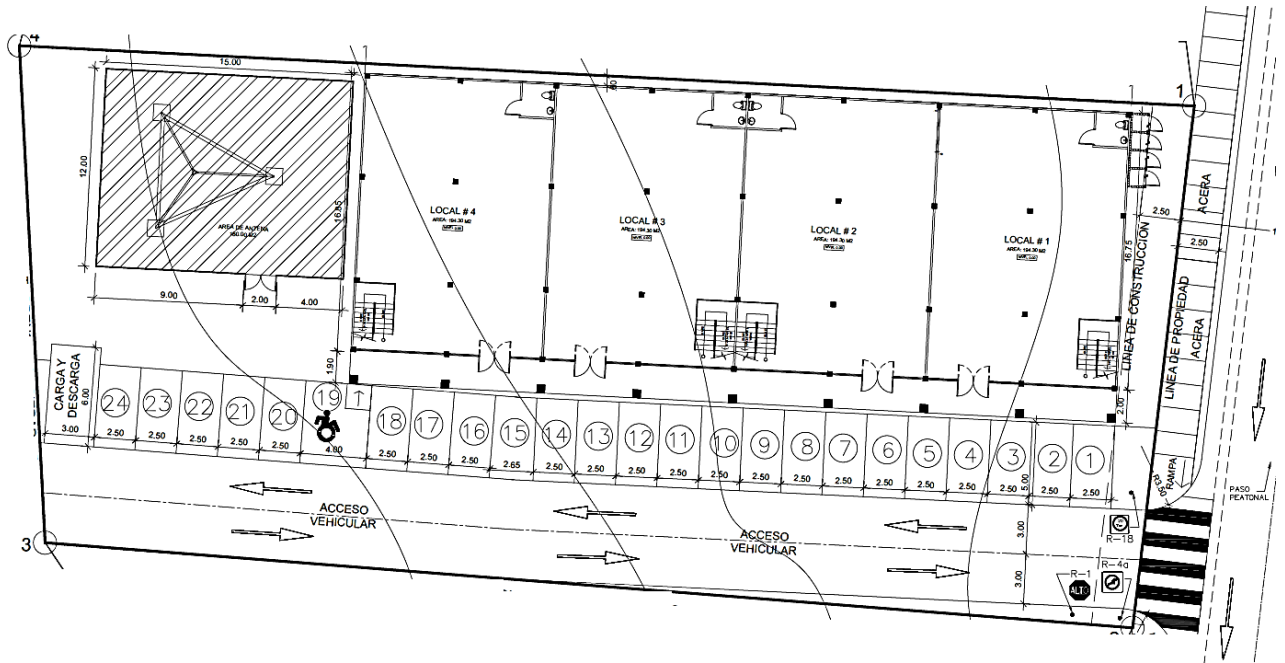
Planta general del proyecto. Fuente: Planos del proyecto, 2024.
